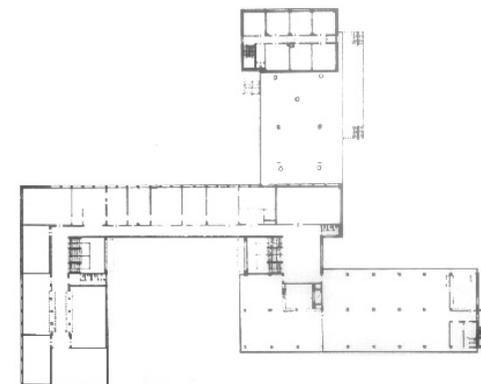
Walter Gropius, Edifício Bauhaus, Planta baixa do primeiro pavimento, 1925 – 1926, Dessau.
